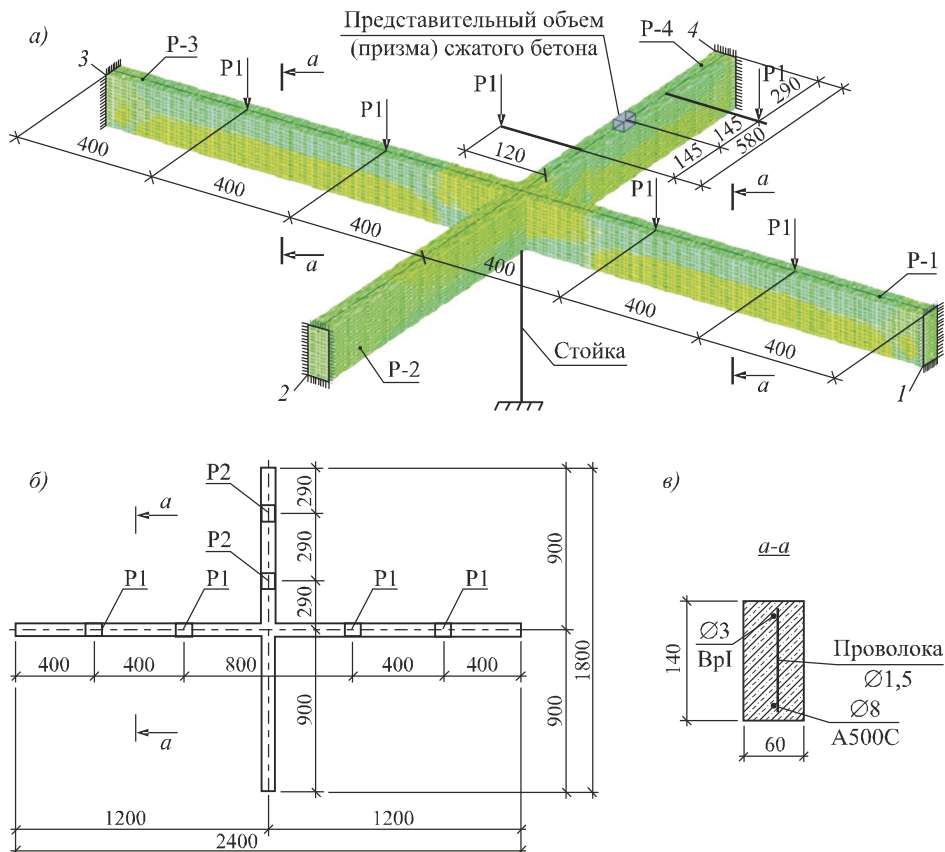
Модель фрагмента железобетонного пространственного каркаса здания в виде системы перекрестных ригелей (а, б); поперечное сечение (в)
